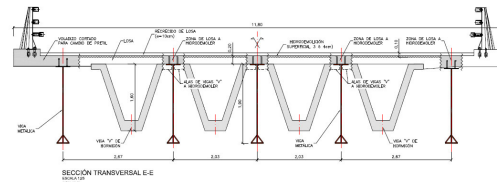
Sección transversal del refuerzo del tablero con vigas metálicas
